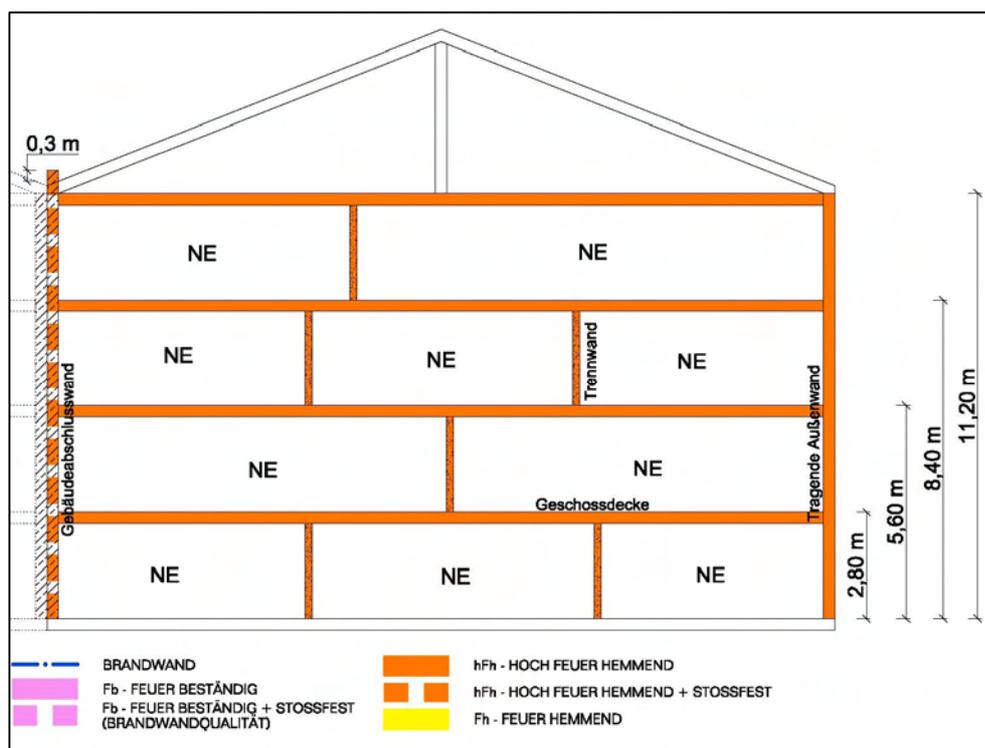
Gebäudeklasse 4 nach HBauO 2013; eigene Darstellung
